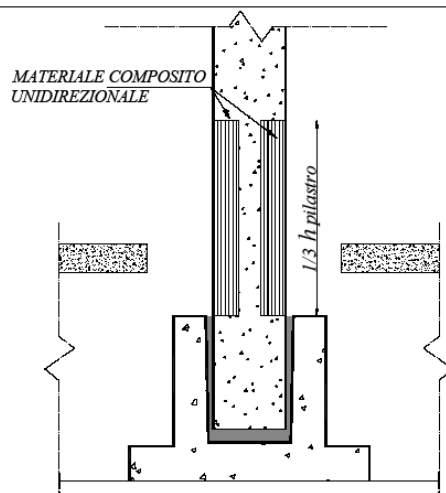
Applicazione del tessuto metallico. Sezione verticale
